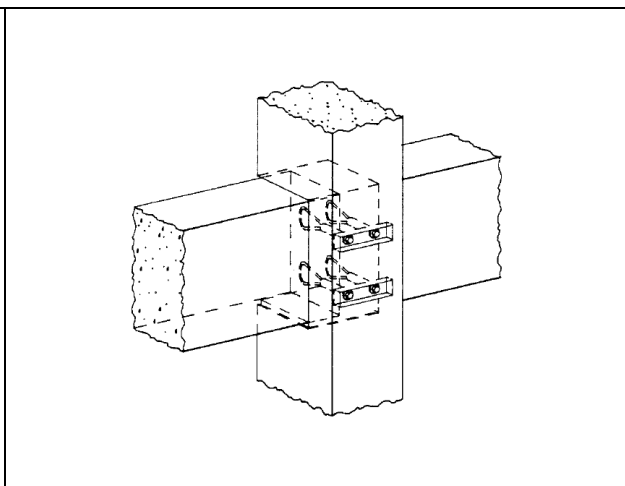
Interrupção de pilar com ligação por grampos roscados (Sidney, 2000)
